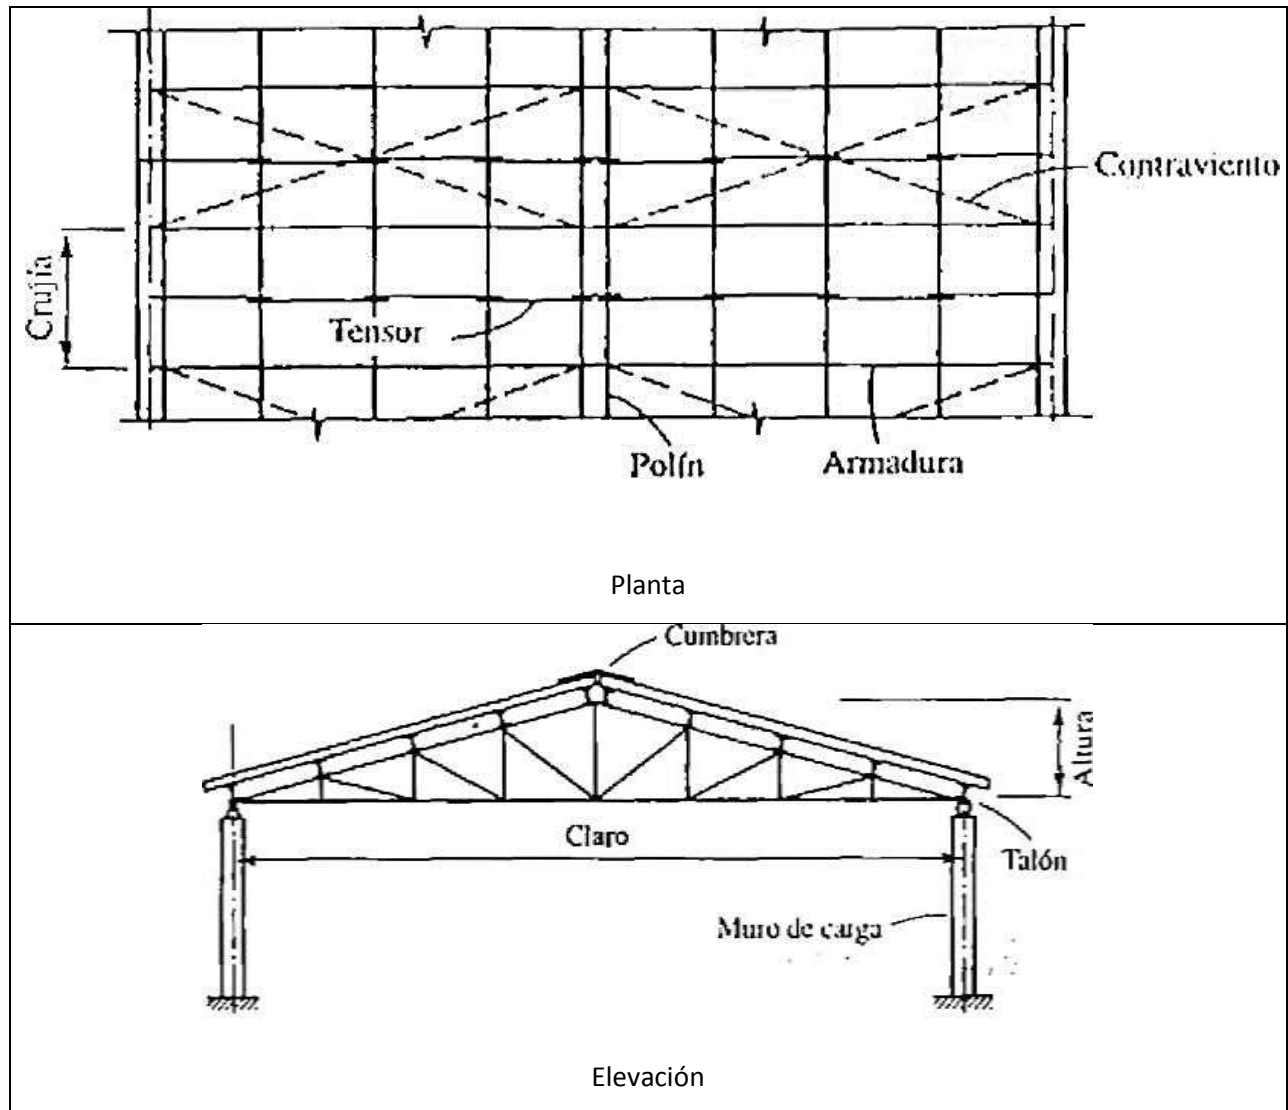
Estructura de armadura de tipo Howe típica en un techo sobre muros de carga
